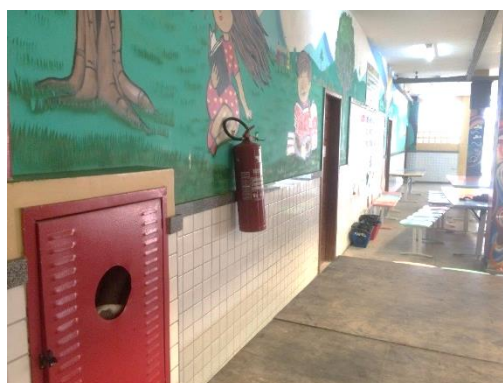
Vista de extintor e hidrante sem sinalização.
